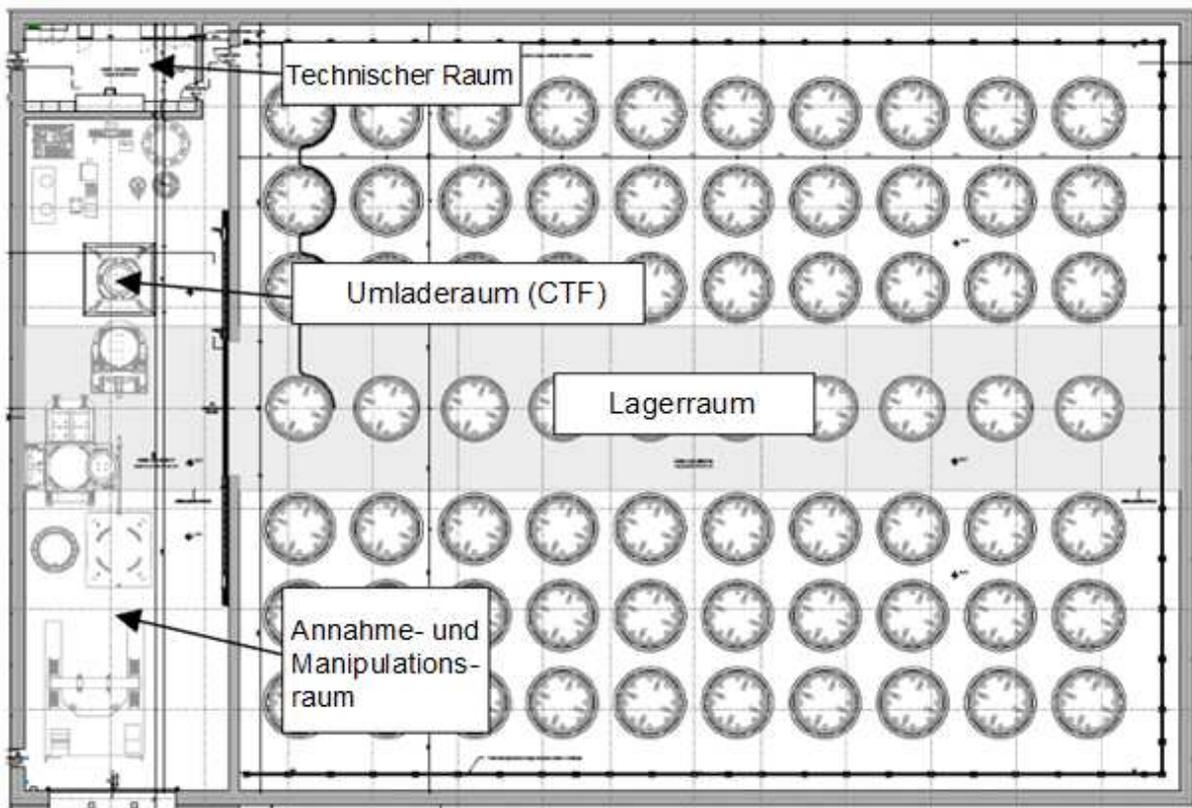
Grundriss des Trockenlagergebäudes für abgebrannte Brennelemente (DSB)
